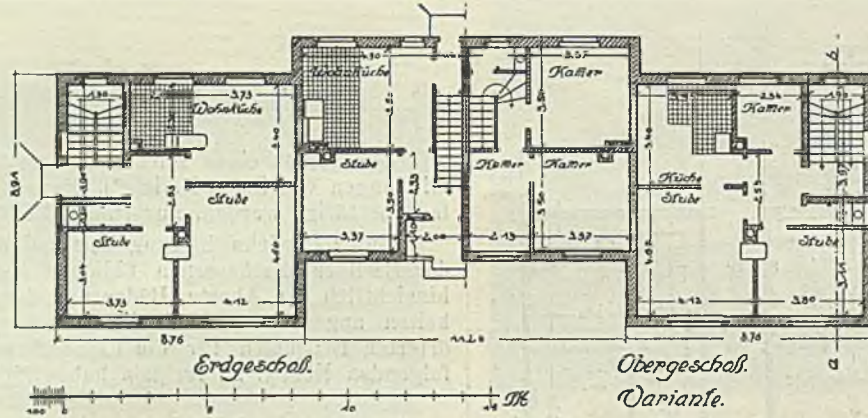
Typisches dreigeschossiges Sechsfamilienhaus in Sachsen (freistehend oder eingebaut)
